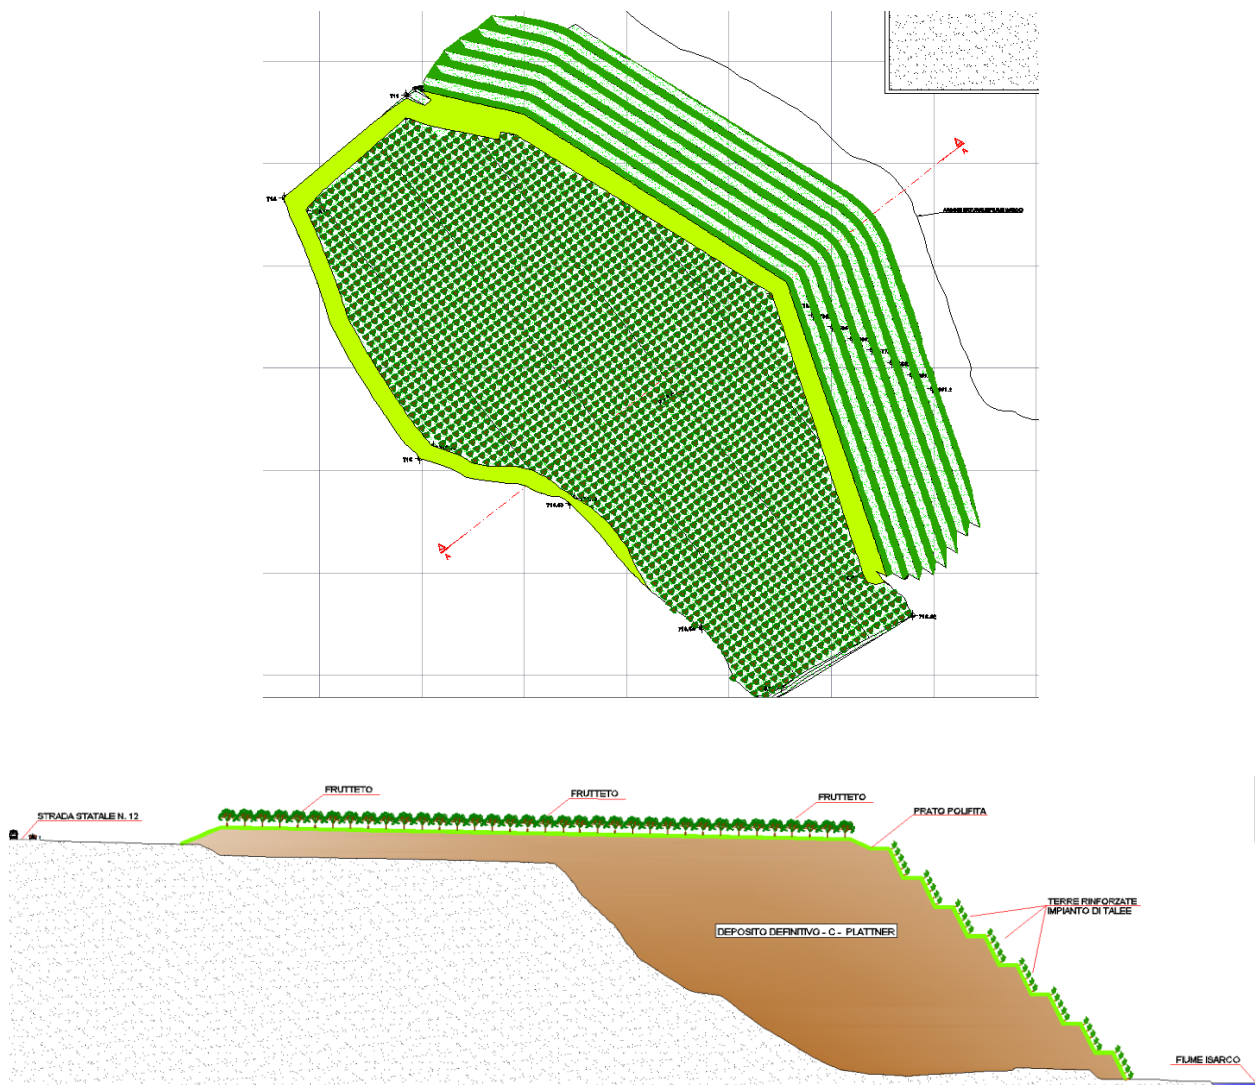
Planimetria e Sezione tipo per ricoltivazione alberi da frutto, presso il deposito C - Plattner.
